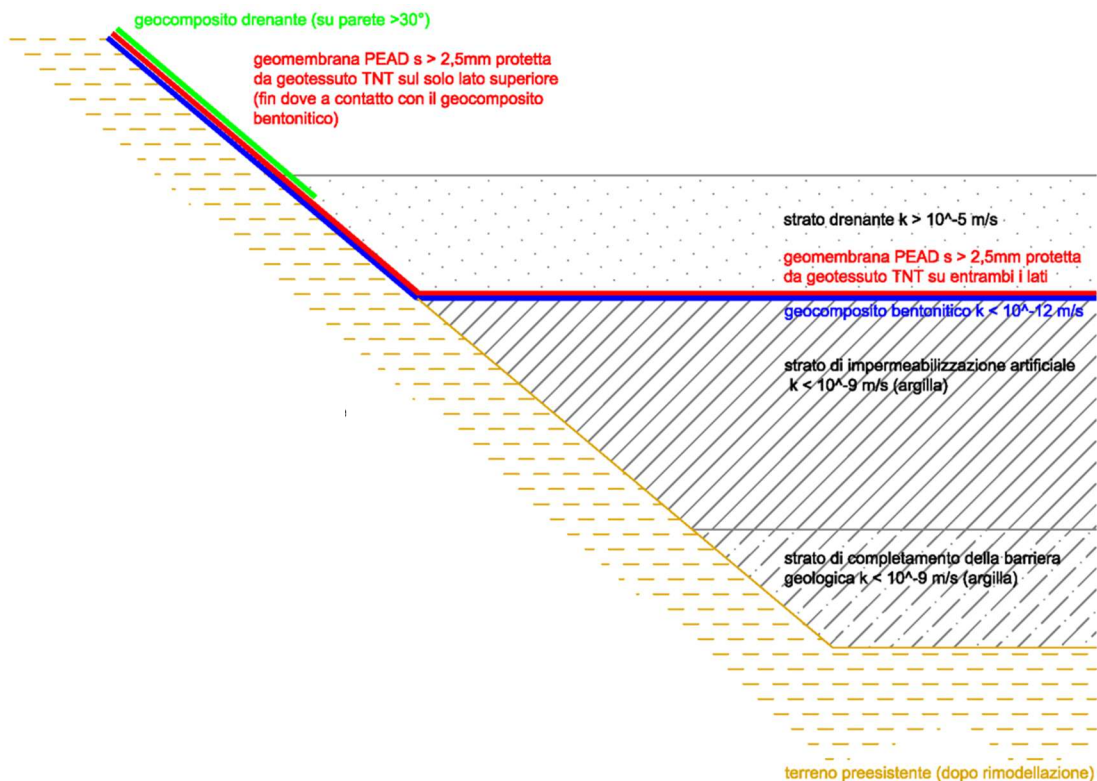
Schema Esemplificativo dell'Impermeabilizzazione della Discarica
